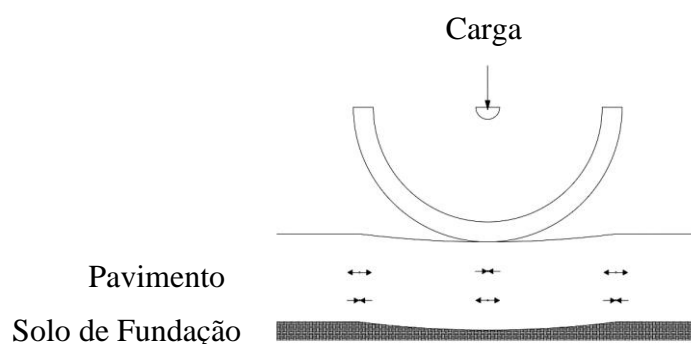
Deflexão do pavimento sob ação do tráfego, com representação das tensões de compressão e de tração nas camadas ligadas
